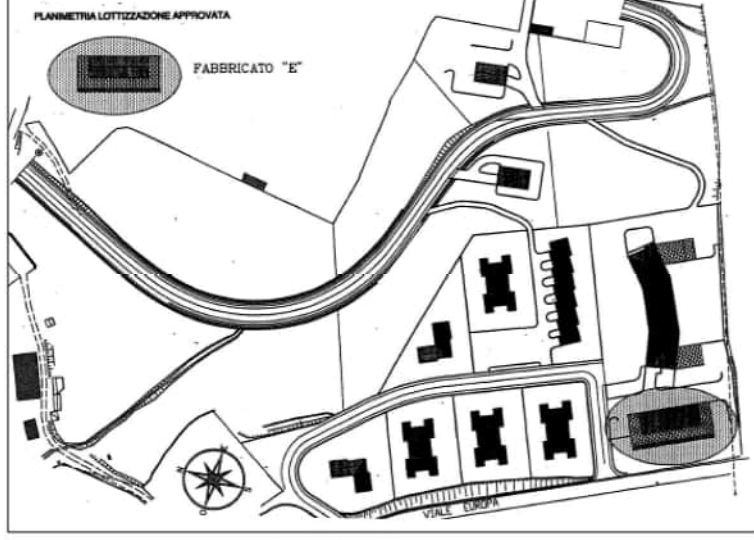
Stralco elaborato progettuale – Planimetria lottizzazione - Ortofoto
